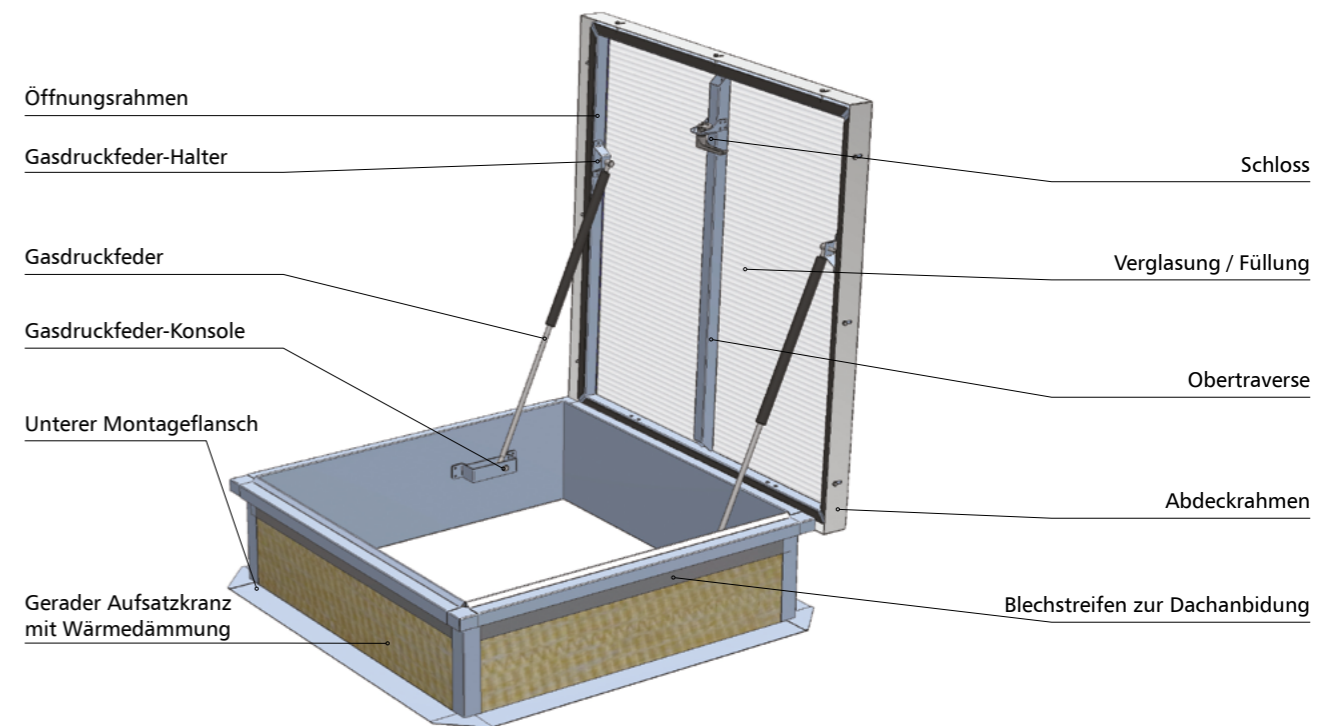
Aufbau eines Dachausstiegs mcr PROLIGHT Typ C
